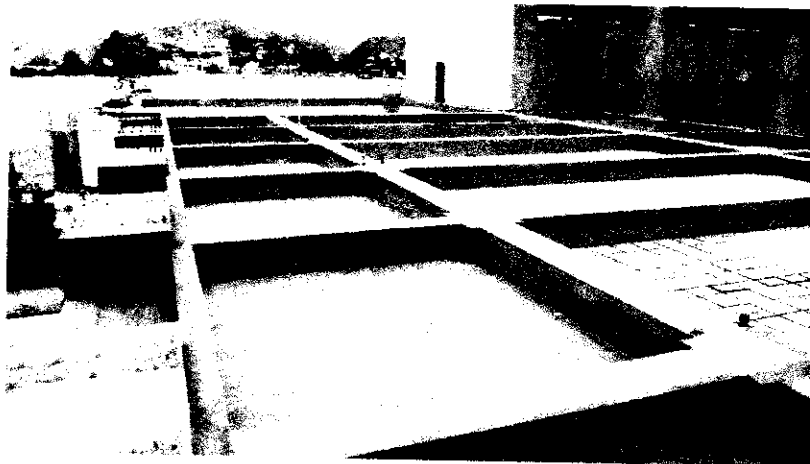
Colocación de ladrillo pastelero en techo de Almacén.
